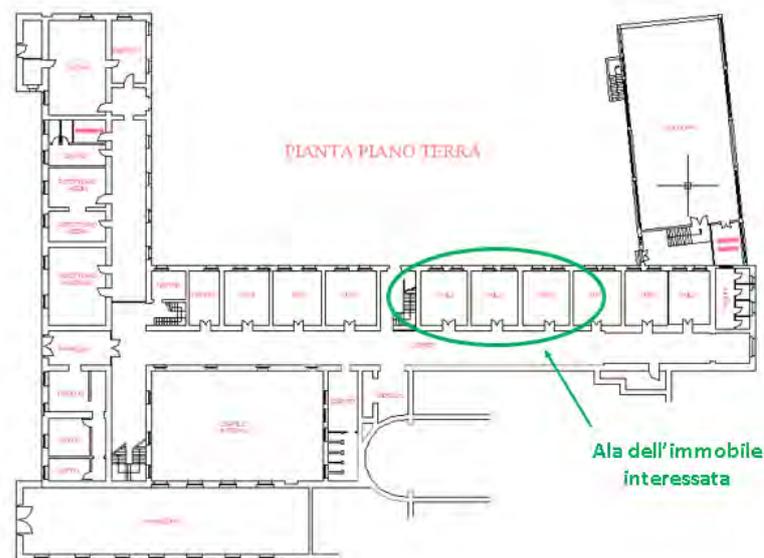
Ala dell'edificio interessata dalle lesioni più marcate sul soffitto
